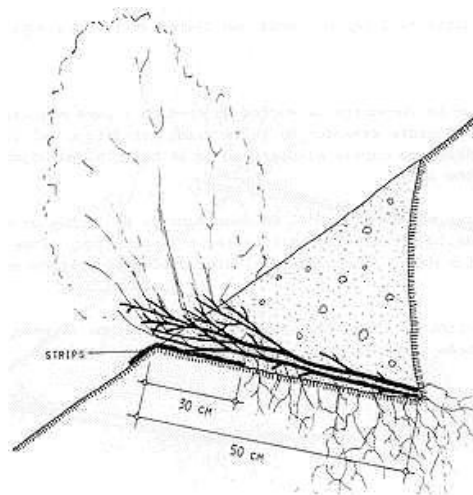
Construcción de lechos de ramaje con fajas longitudinales.
